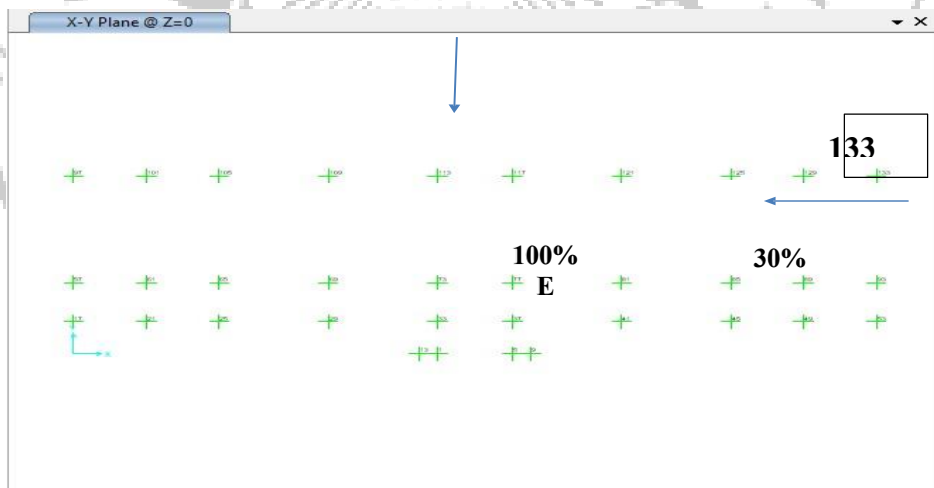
Denah dan pembebanan lantai 2 dan lantai 3
